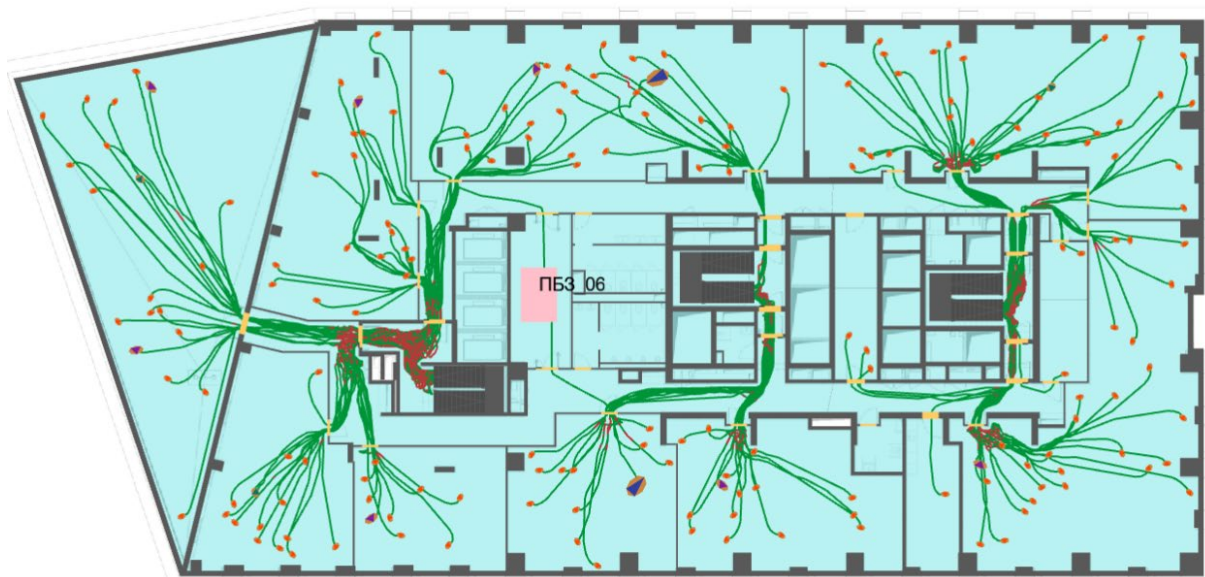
План 6-го этажа и нанесенная на него расчетная (принципиальная) схема эвакуации
